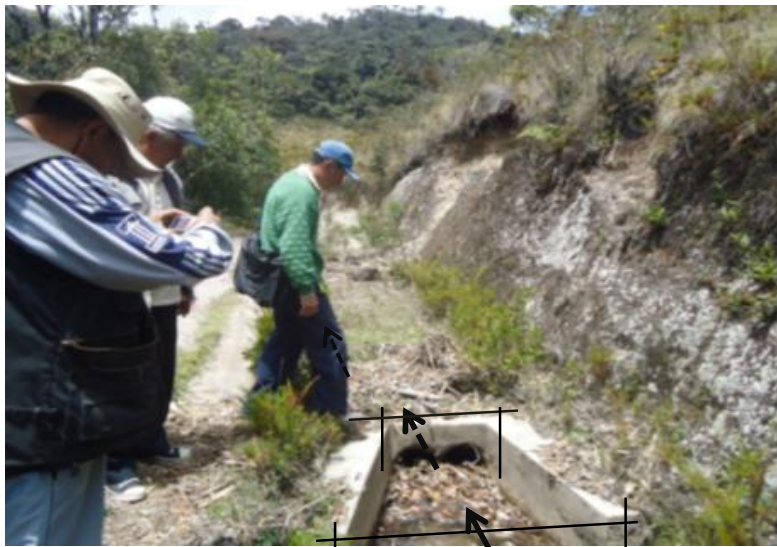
Foto del canal Ocshawilca I; se observa un tramo acondicionado con tuberías, con capacidad menor a la del canal
